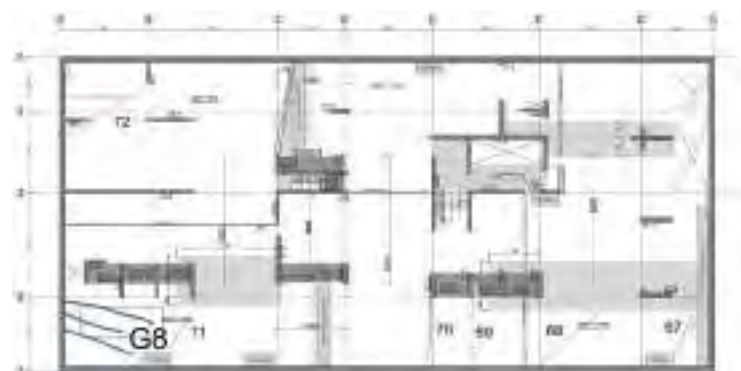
Grupo de Fisuras G8 (1)
